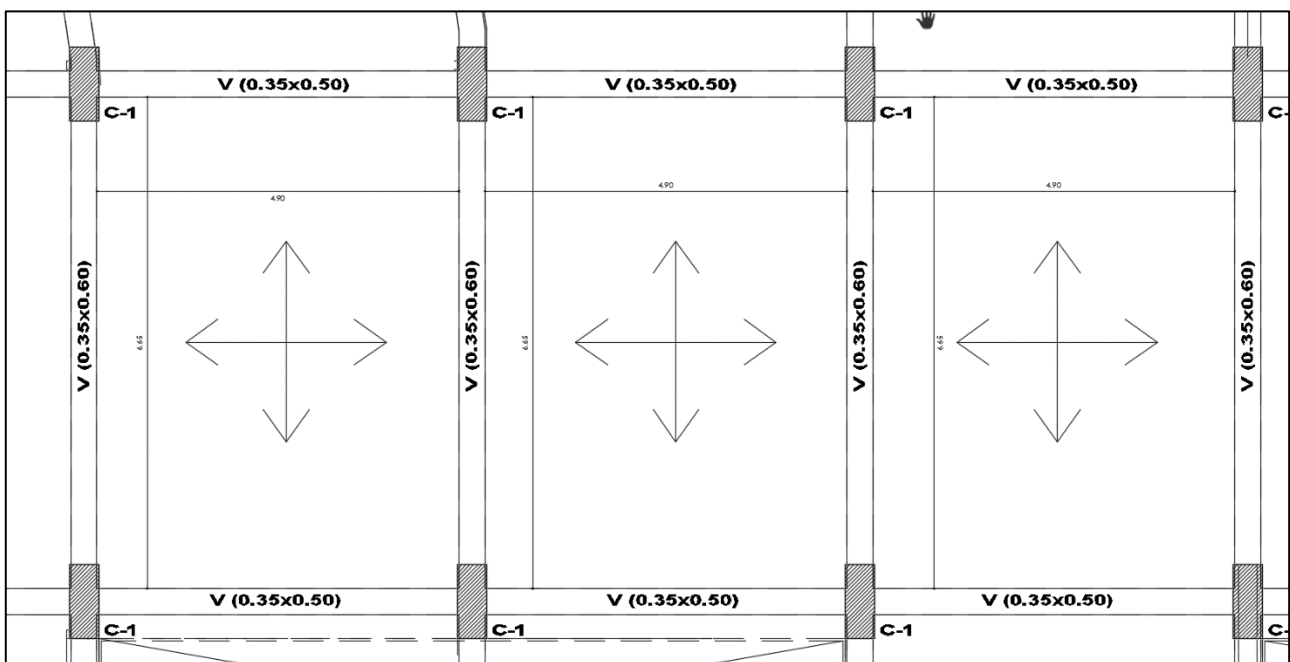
Losa Aligerada Ubicada entre los Ejes 4 y 7 interceptado con los ejes F y D
